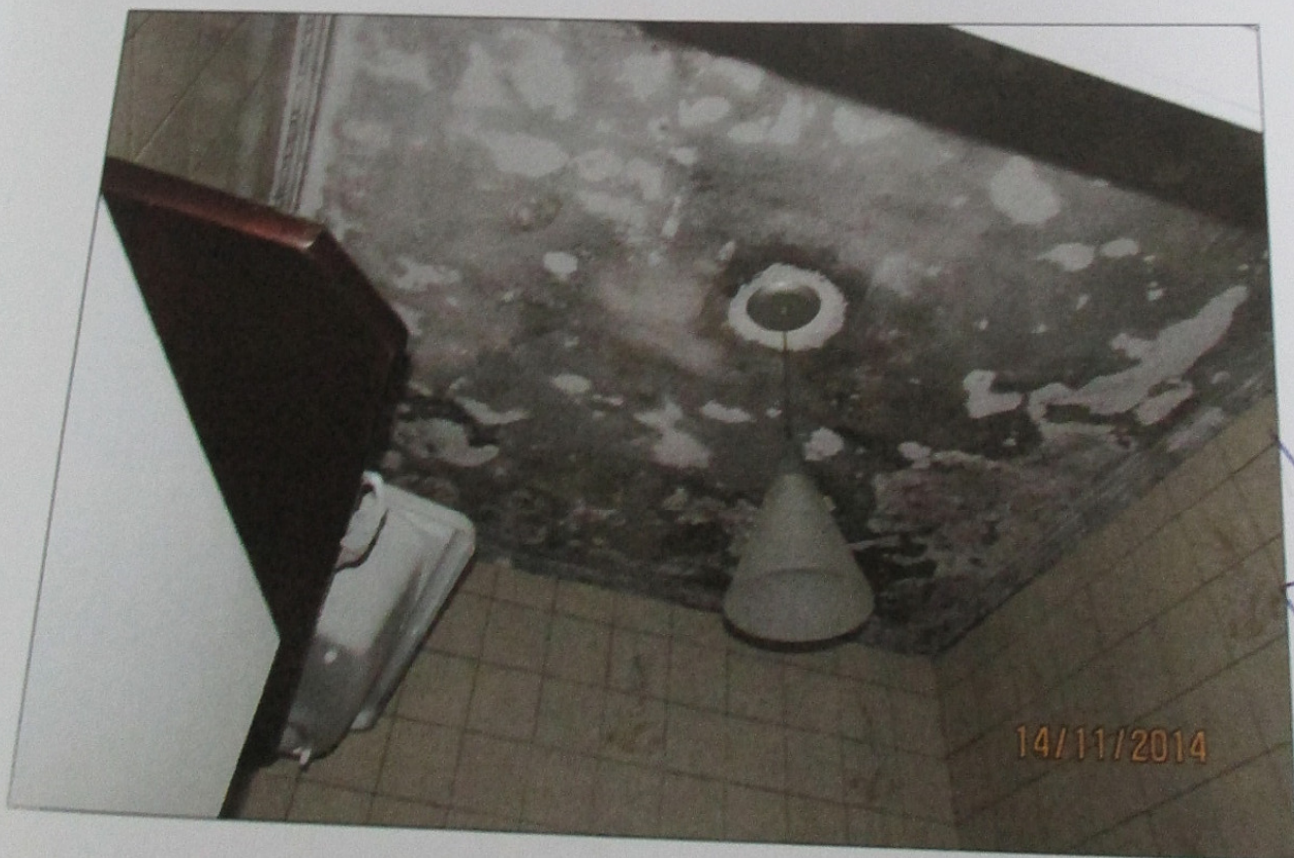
Vista do teto do banheiro, com rotato, e que demanda conservação.
